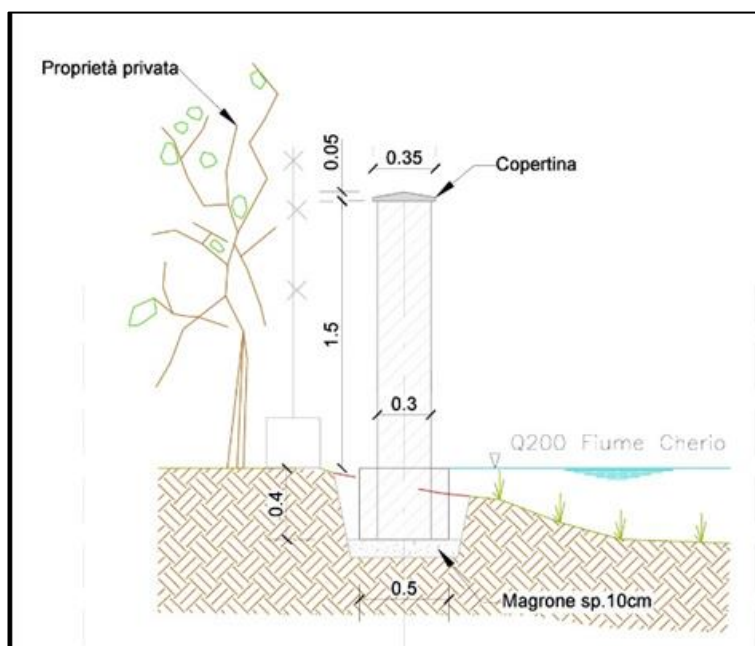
Sezioni tipo intervento muro arginale in c.a. (sponda destra)
